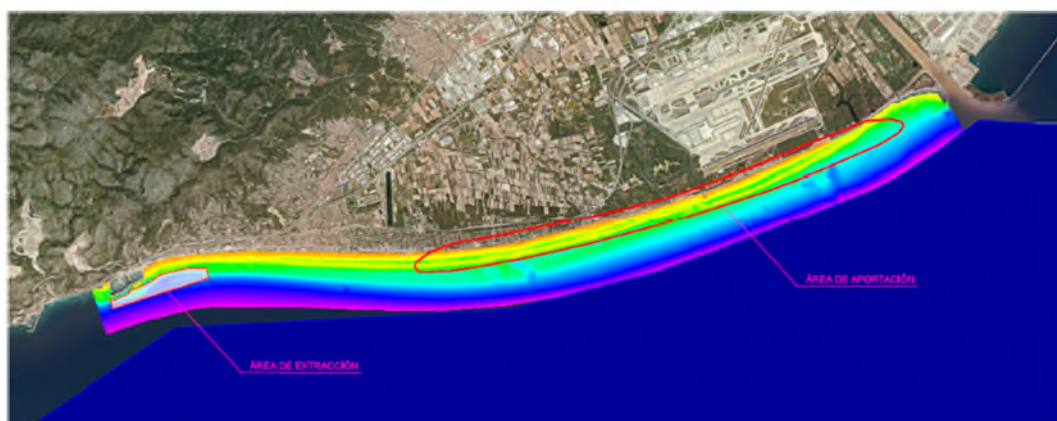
Ámbito del proyecto. Vista general de la zona de extracción y zona de aportación.
